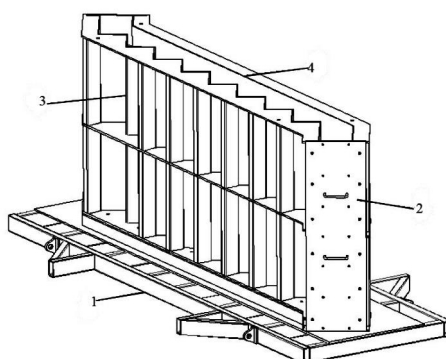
预制混凝土楼梯立式钢模具示意
